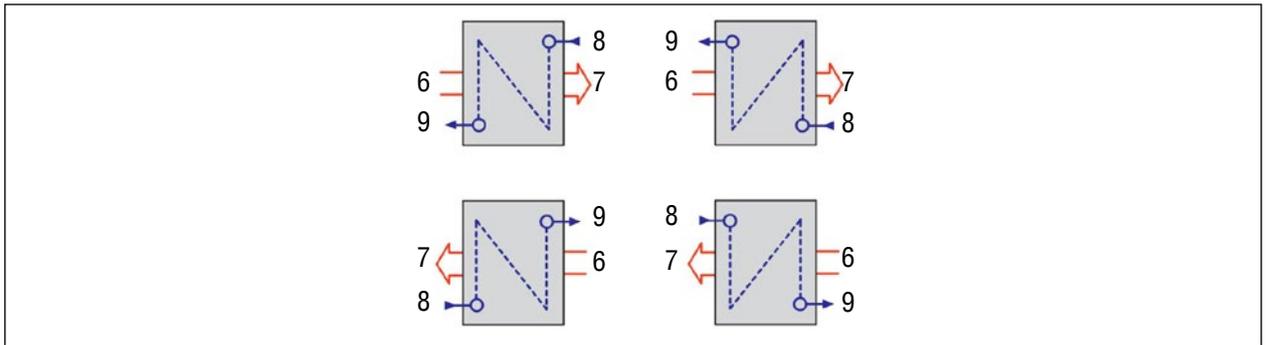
Wärmetauscheranschluss Gegenstromprinzip
